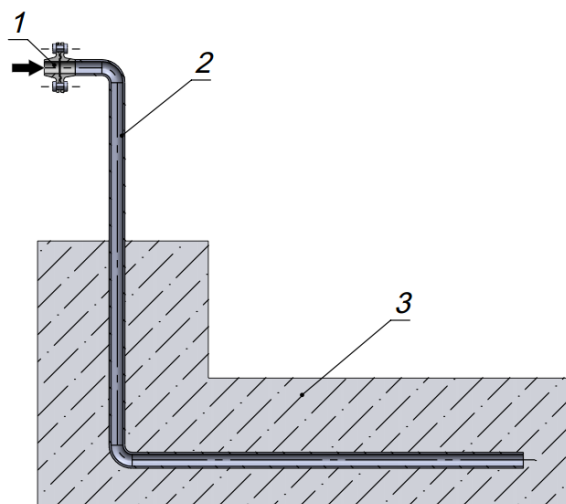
Розрахункова схема. 1 – фланцеве з'єднання; 2 – труба; 3 – ґрунт
